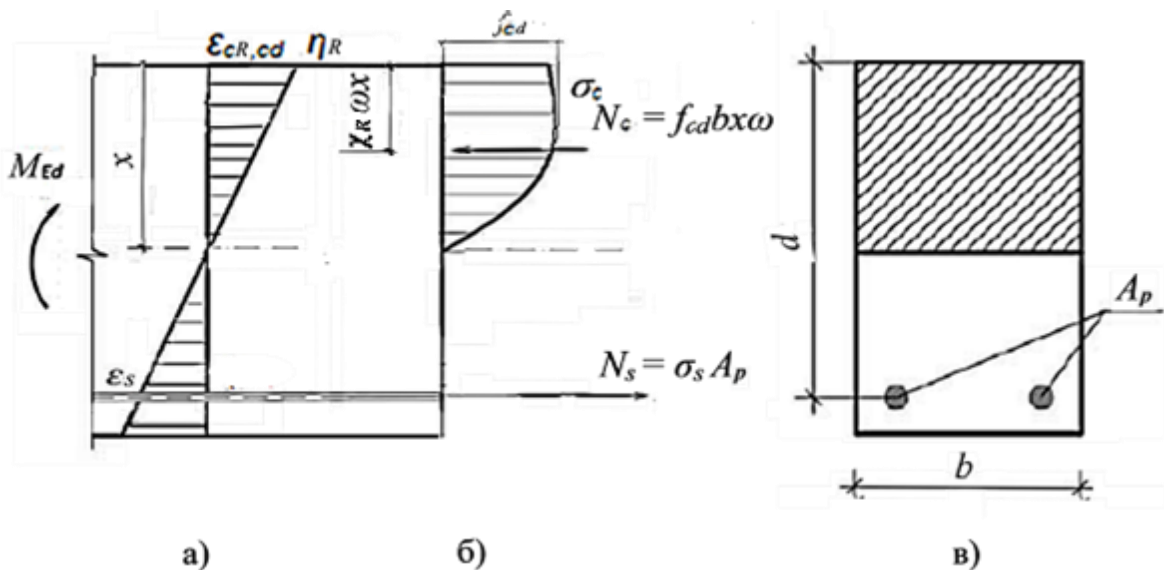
Розрахункова схема армованої високоміцною арматурою залізобетонної конструкції у нормальному перерізі: розподіл деформацій (а), напружень і зусиль (б); поперечний переріз (в)
